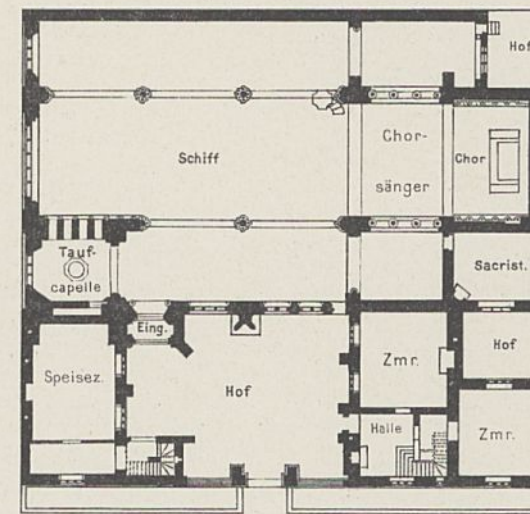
Allerheiligenkirche in Margaret Street London. Architekt Butterfield.
